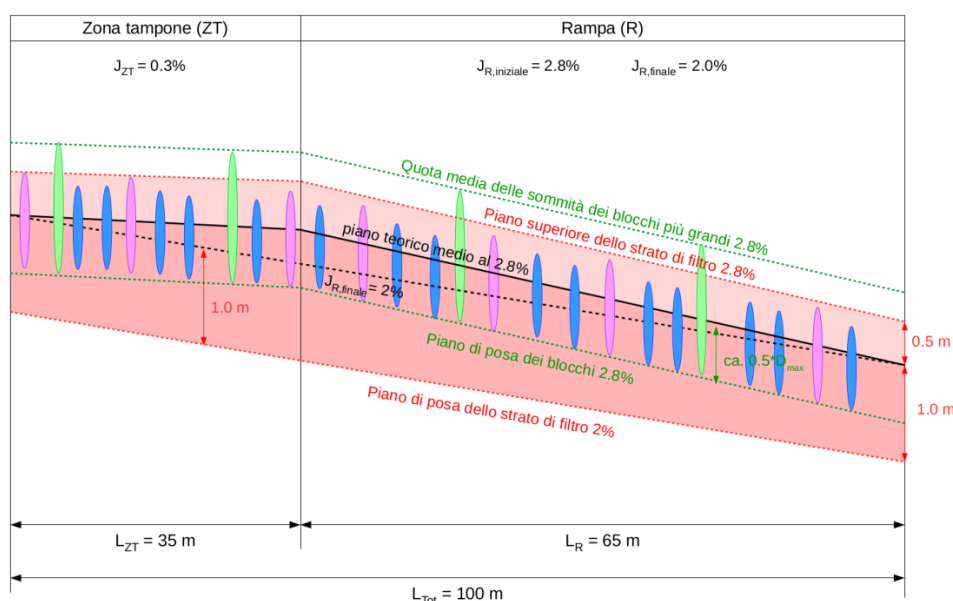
Schema profilo longitudinale rampe fornito da Laboratorio 3D
